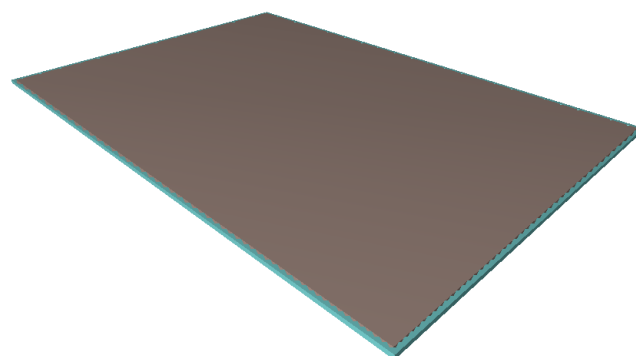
Ejecución de la losa de cimentación. Fuente: Propia.
